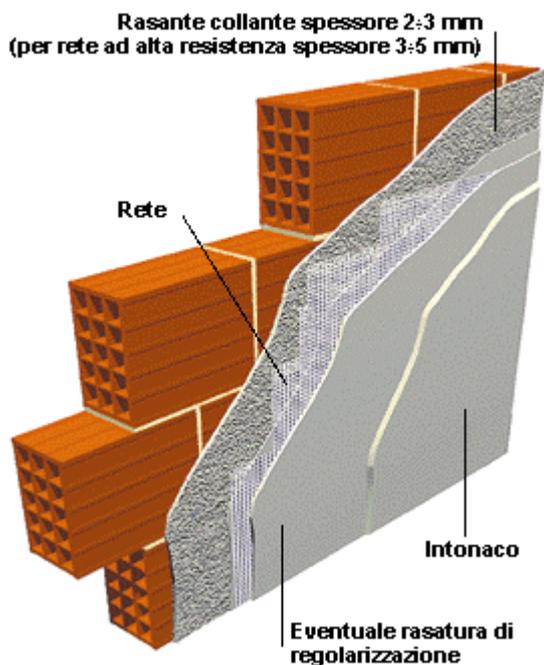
a) Intonaco armato con rete immersa in uno strato di rasante collante (spessore 2-5 mm secondo il tipo di rete).
